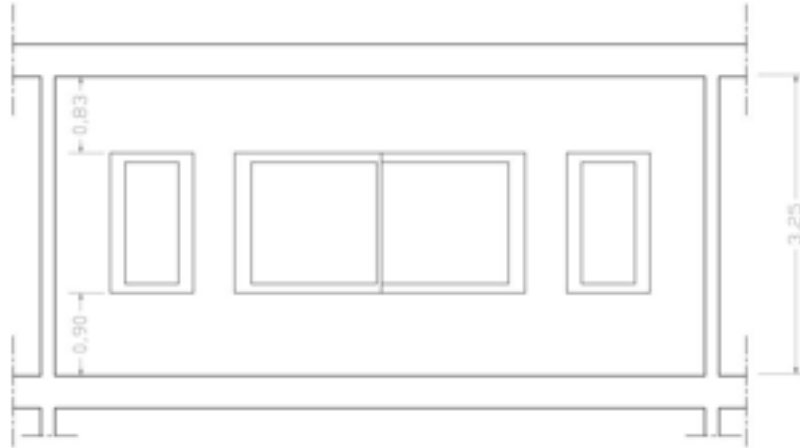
Sezione dell'aula oggetto delle misurazioni
